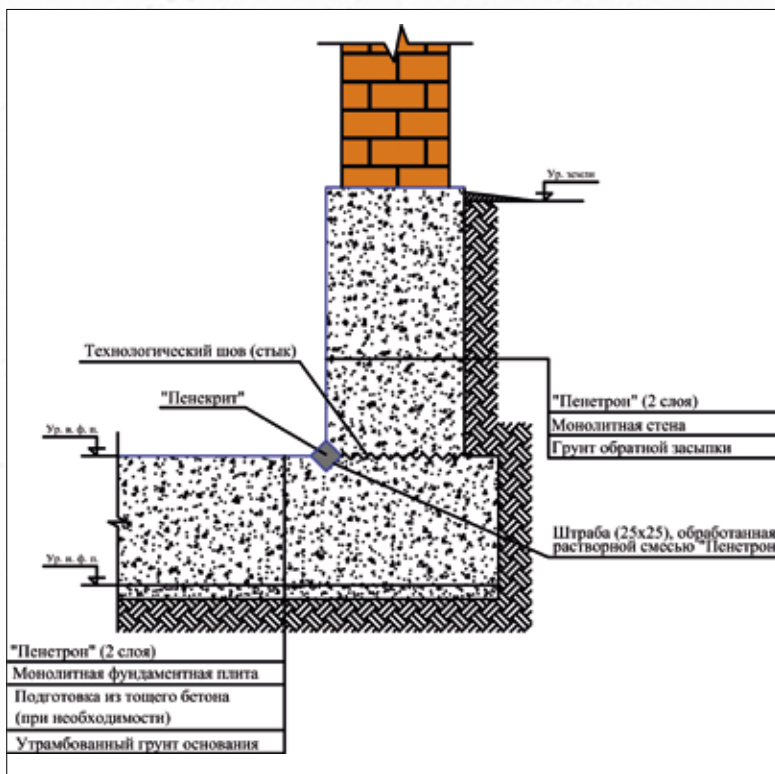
Устройство горизонтальной гидроизоляции между бетонным фундаментом и стеной
